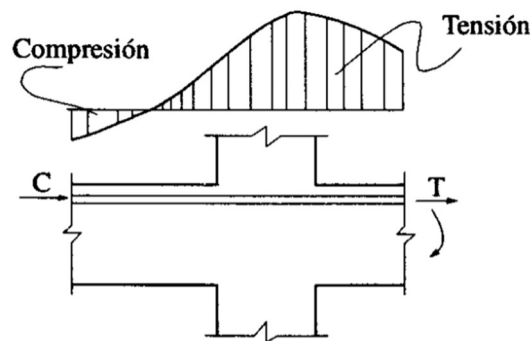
Distribución de esfuerzos en la unión de una columna y una viga (Bazán y Meli, 2018).
